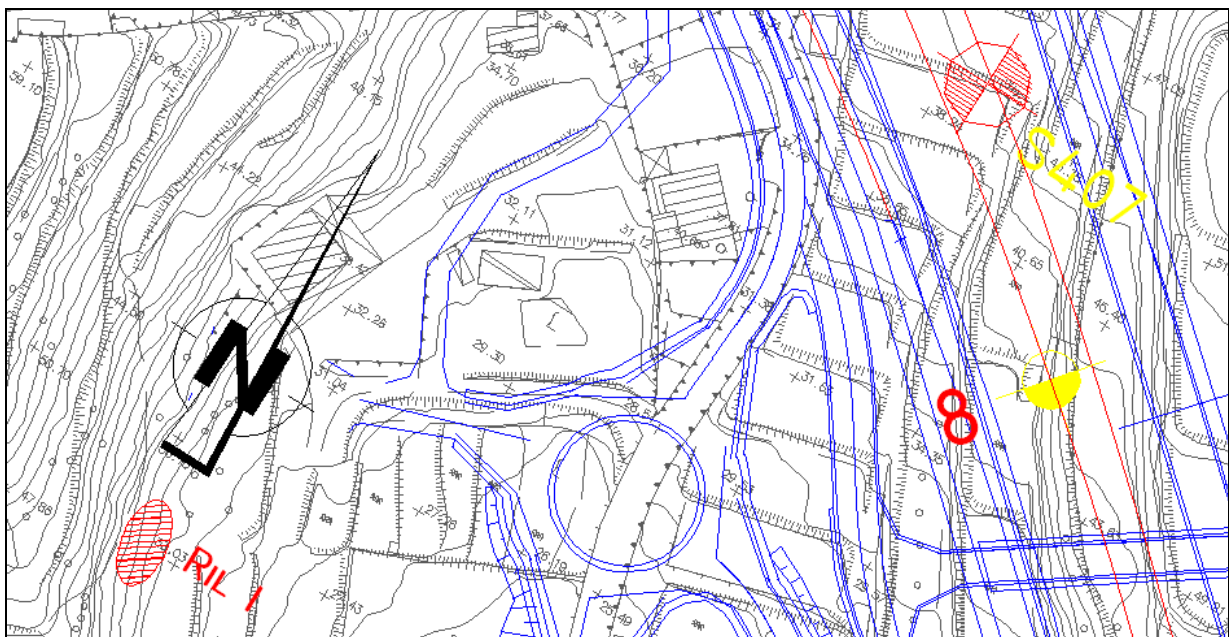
Ubicazione in planimetria dell'affioramento oggetto del rilievo geostrutturale
